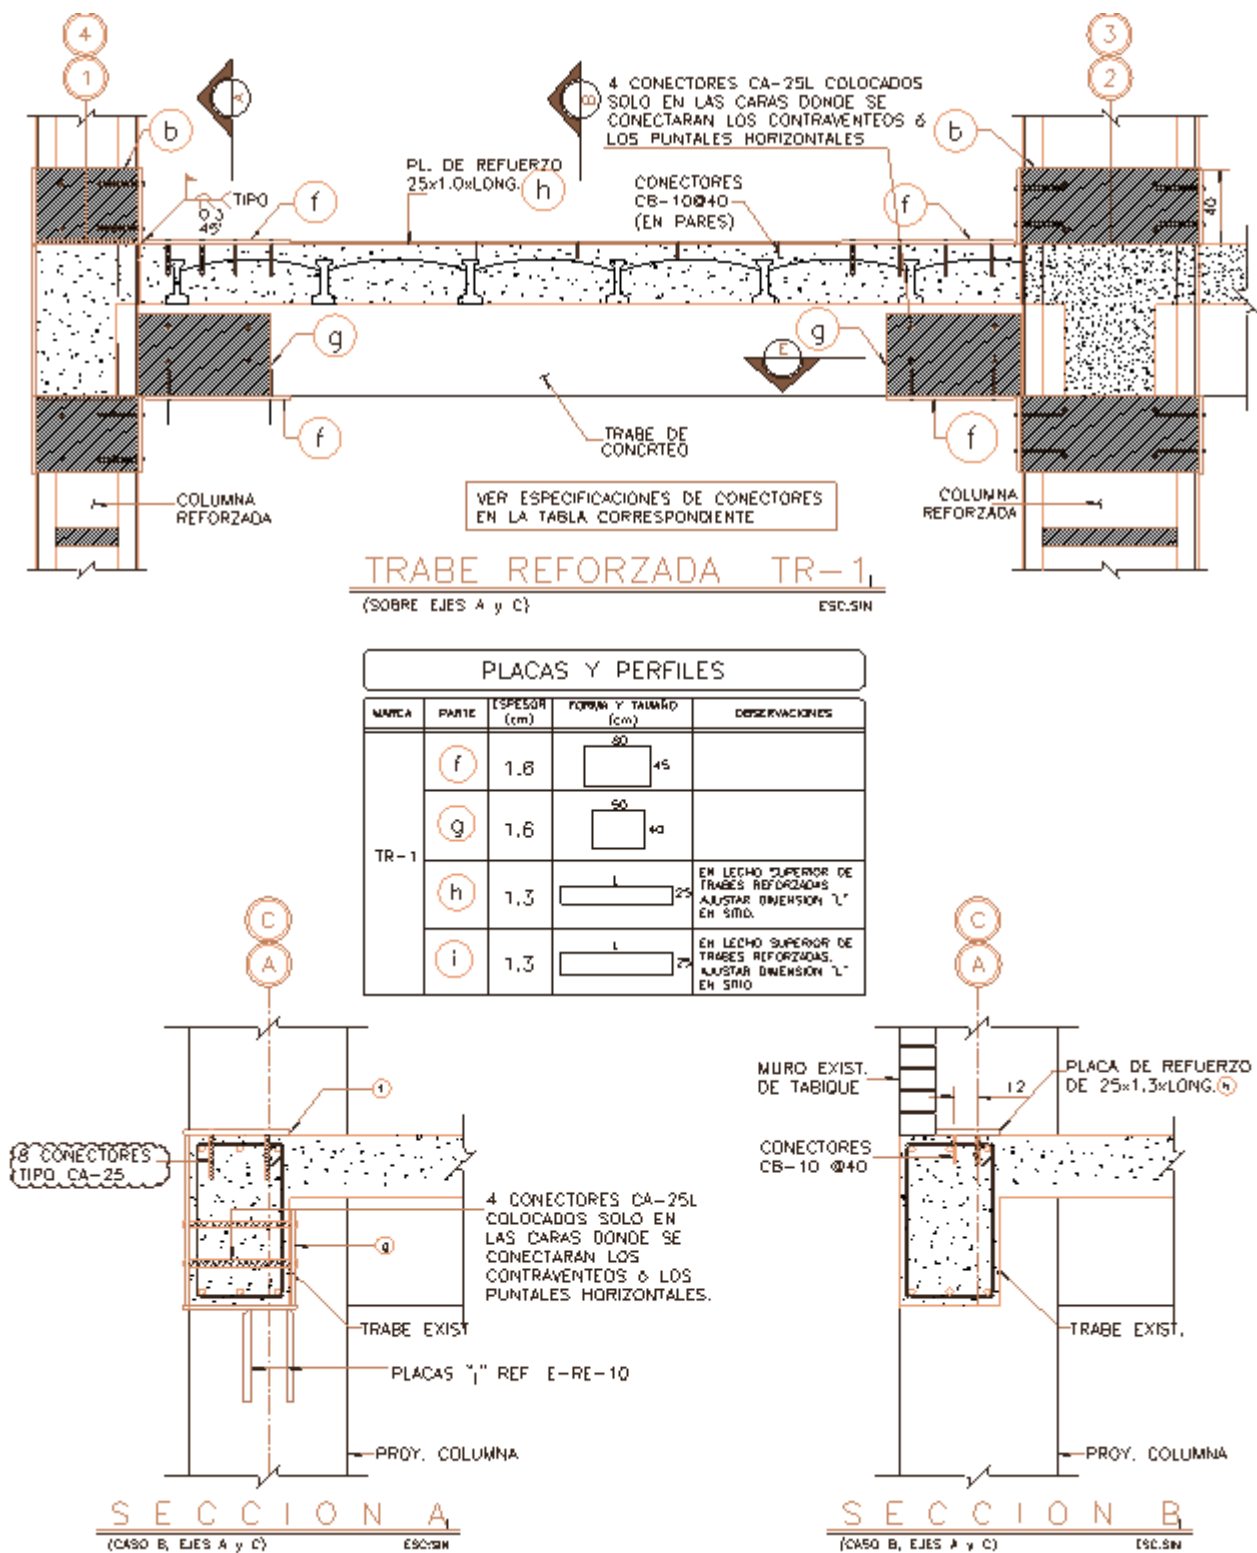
Detalles de los refuerzos de vigas del edificio Río Lerma, tomado de Arellano Méndez (2020).
